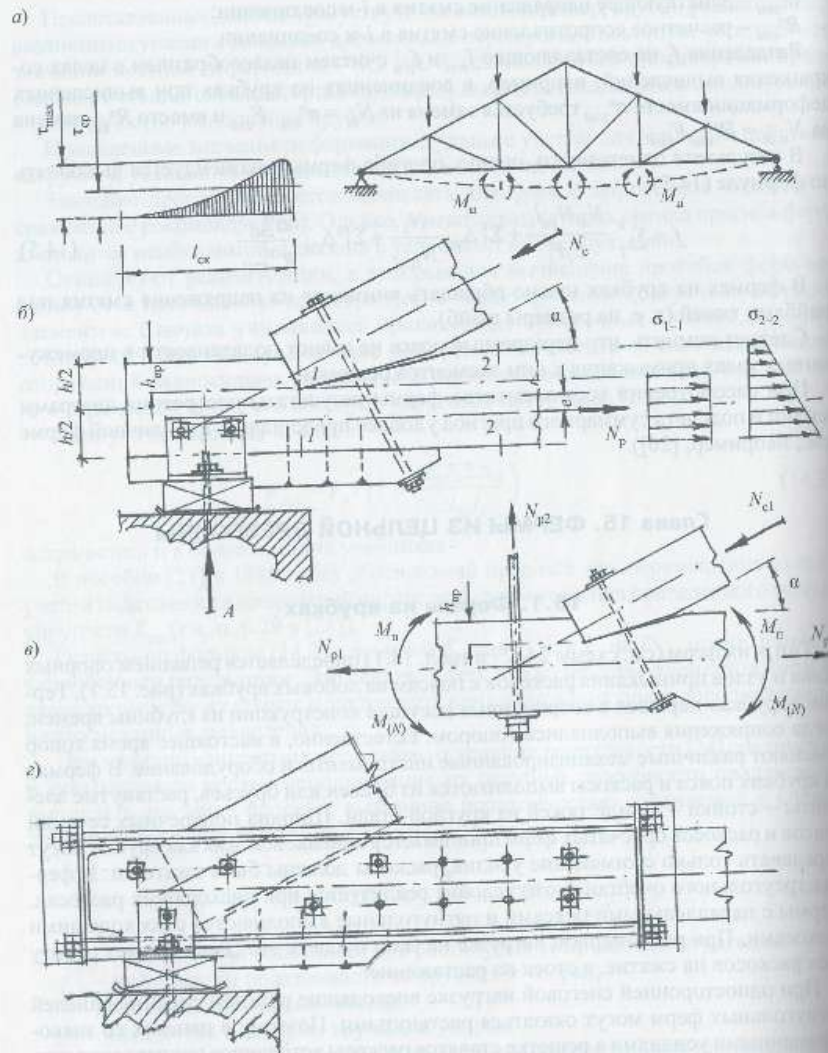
Схема и узлы треугольной фермы: а – схема фермы; б – вариант опорного узла на врубке с одним зубом; в – промежуточный узел фермы; г – опорный узел на натяжных хомутах
